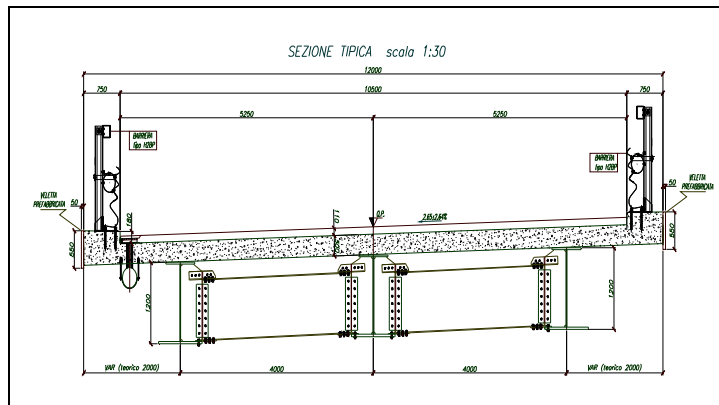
Sezione tipo impalcato Ponte Scolo Buoncambietto
